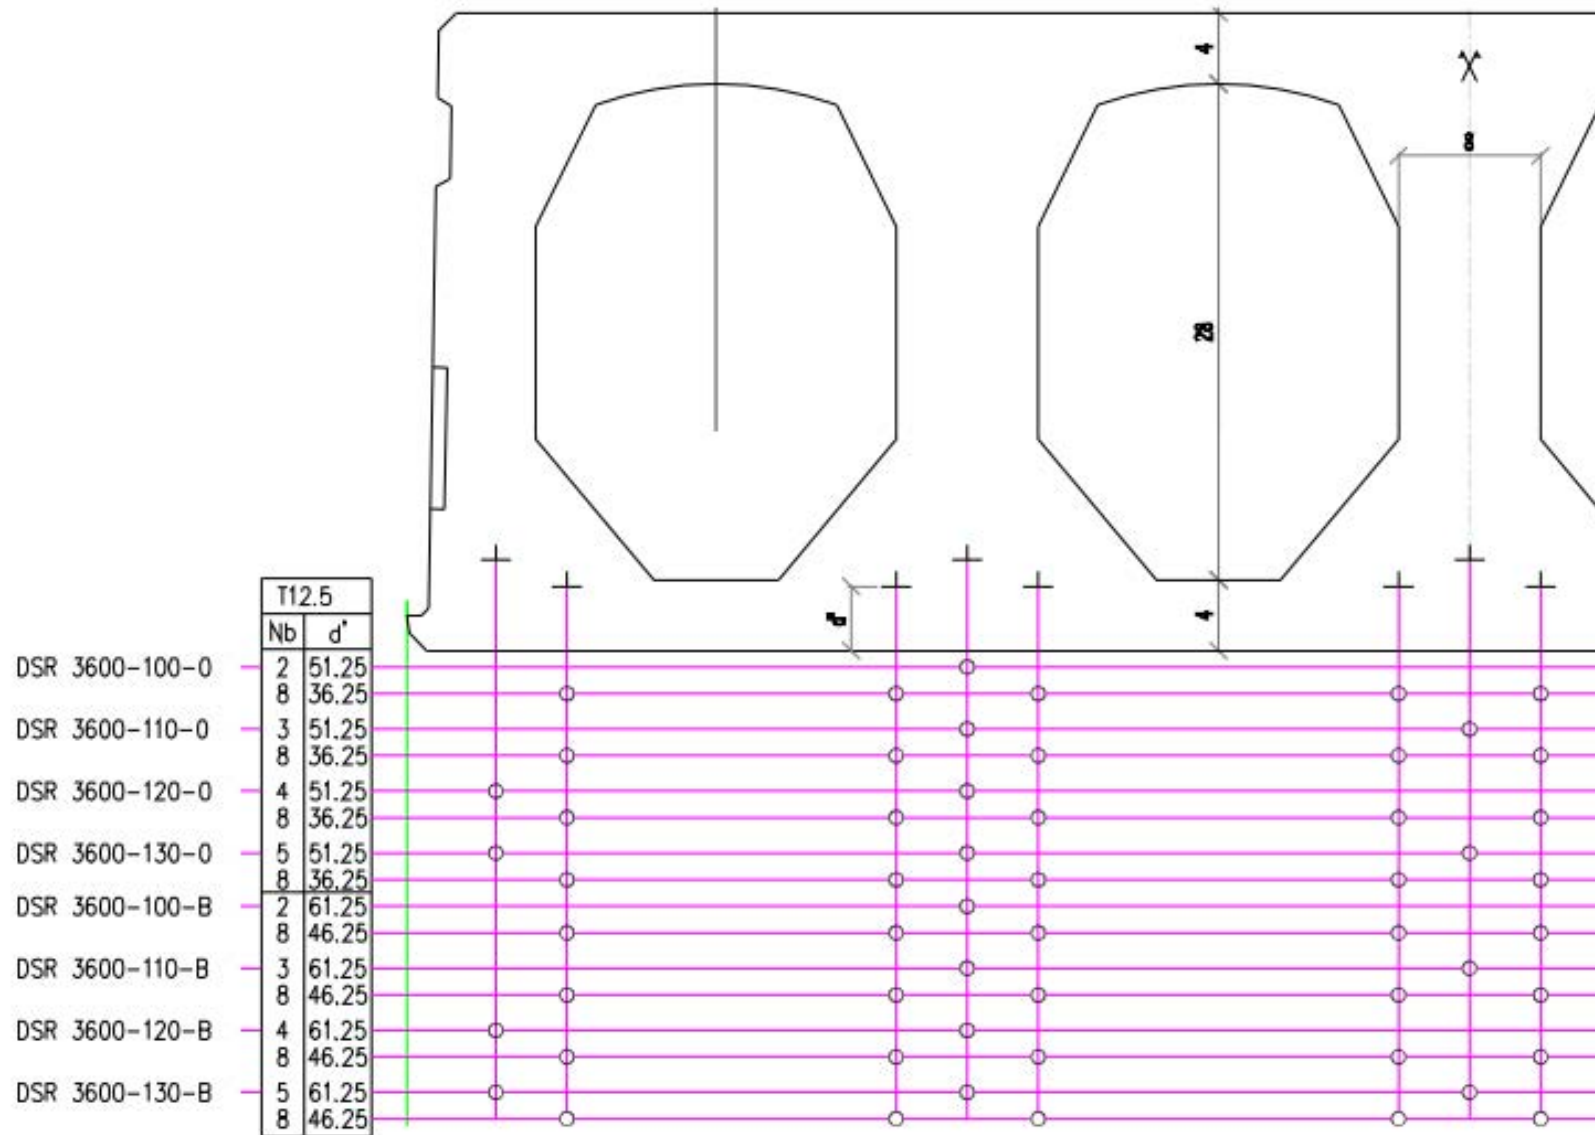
Dalle DSR 3600 - Position des armatures de précontrainte
